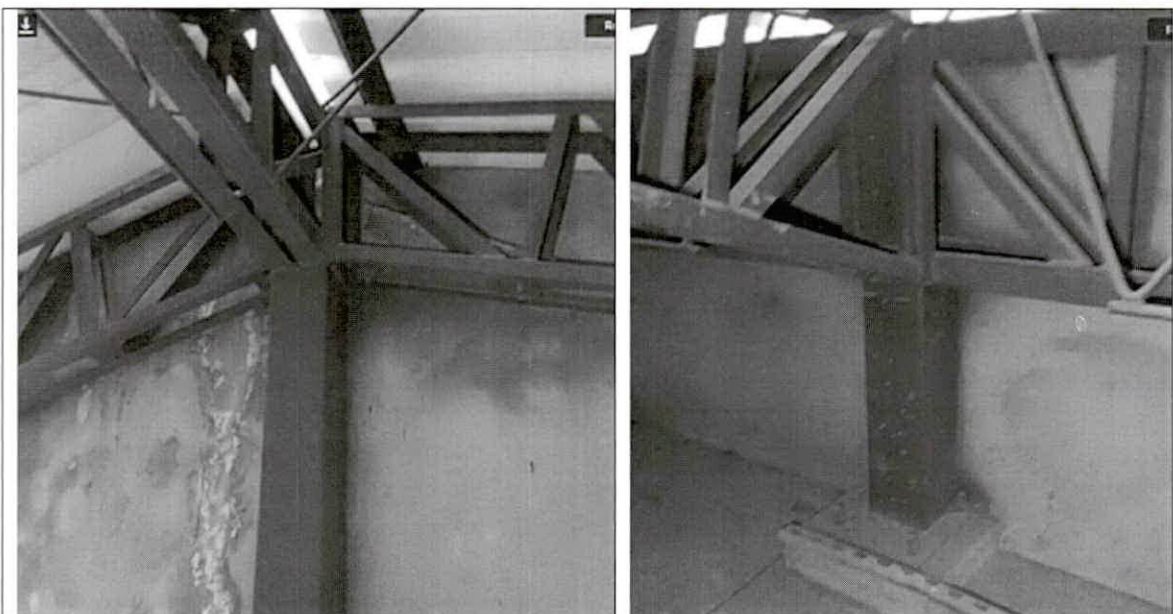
Inspección de la estructura de la cobertura metálica – Sector C1. En la imagen se observa la conexión de la columna y vigas tipo celosía.
